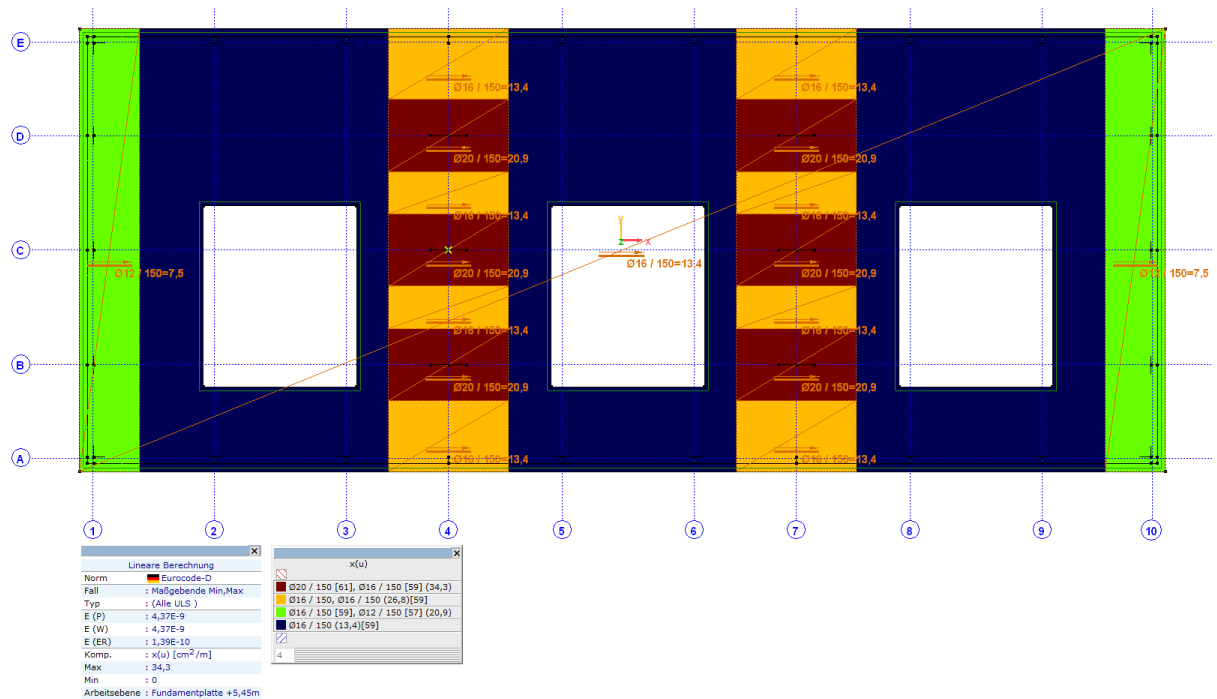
Entworfenere untere Bewehrung in lokaler x-Richtung
